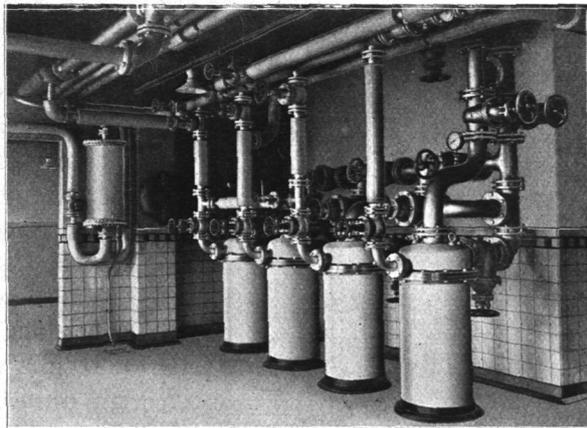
Badeanstalt Hammerbrook, Warmwasserbereitung.
